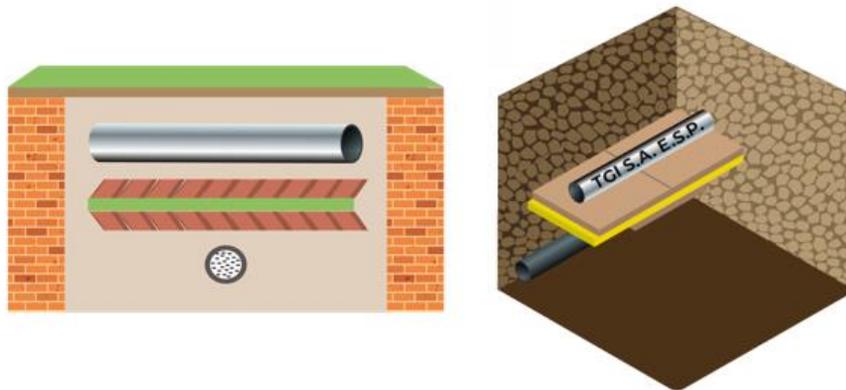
Protección con baldosas, losetas o placas de cemento más planchas de caucho sintético o placas de PRFV-cruce.
